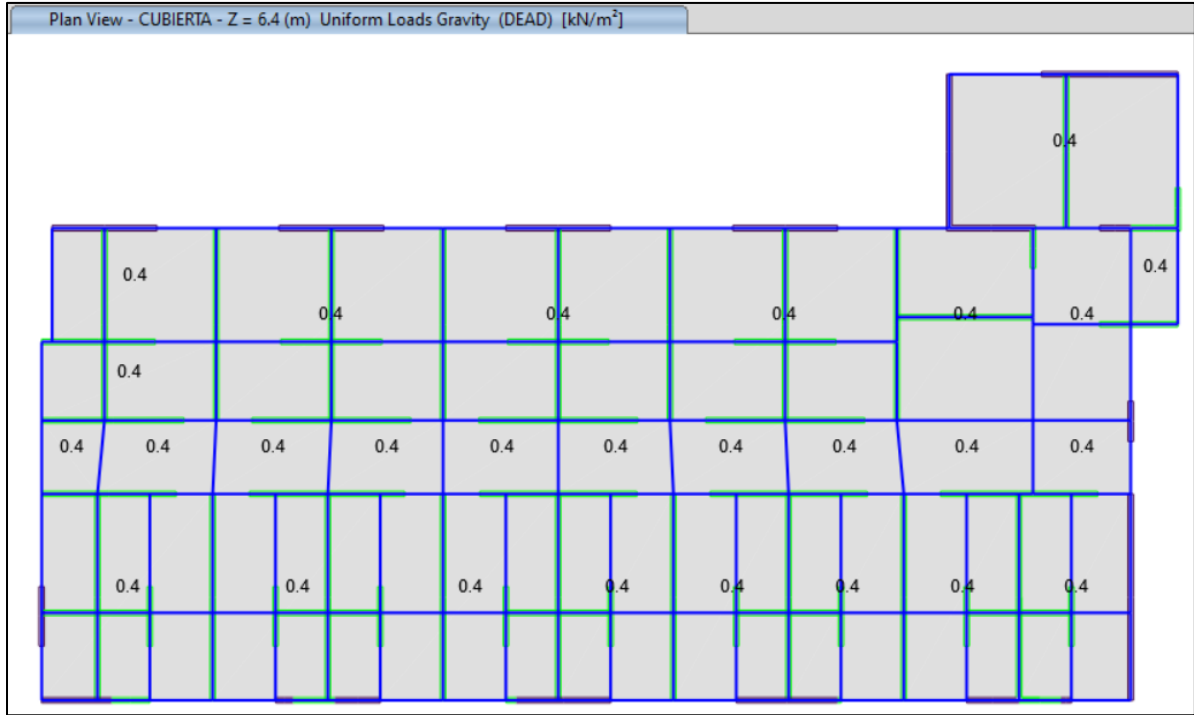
Asignación de cargas muerta de cubierta sobre slap tipo membrana [kN/m²].
